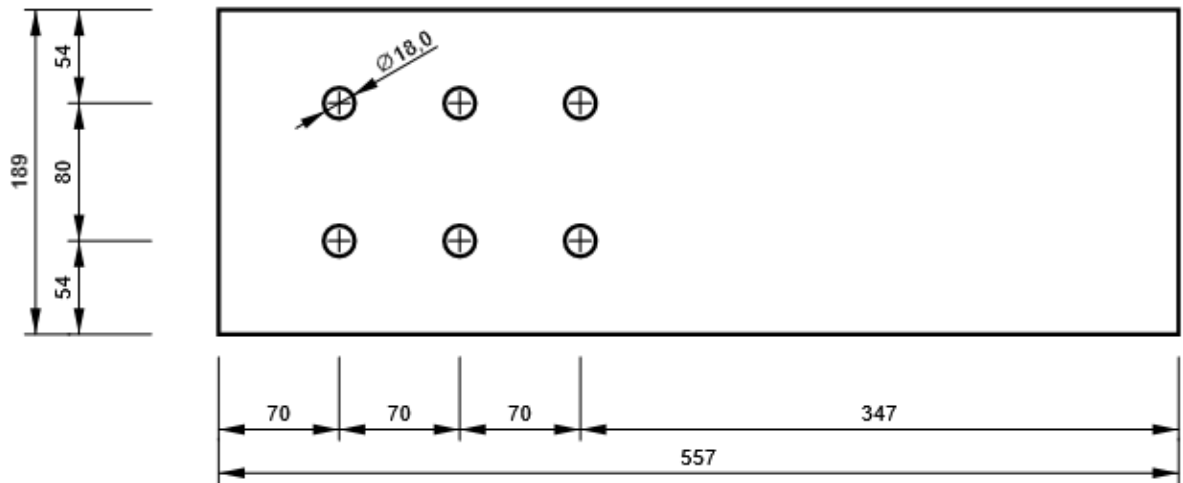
Dimensions et disposition des boulons sur l'âme du contreventement.
